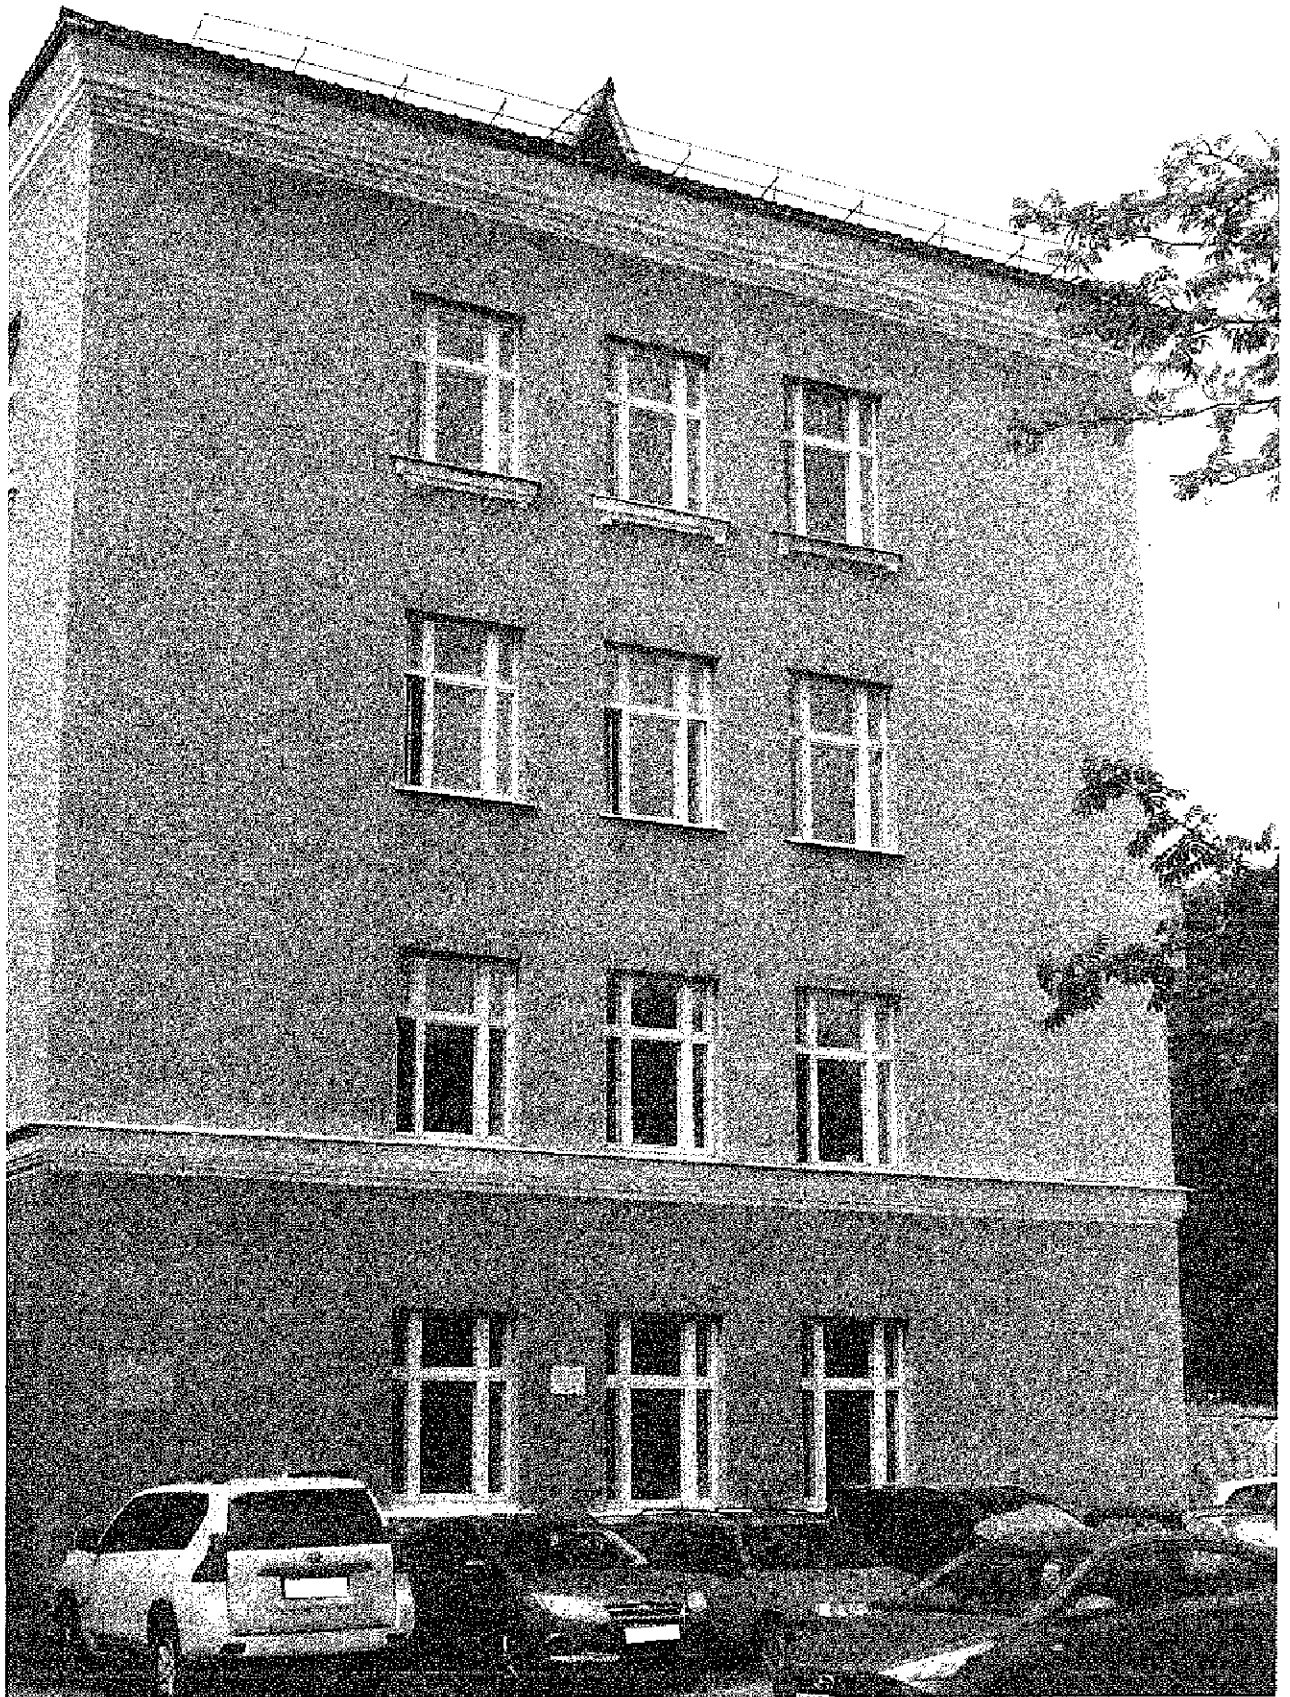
Восточный фасад здания. Дата: 14.07.2021
